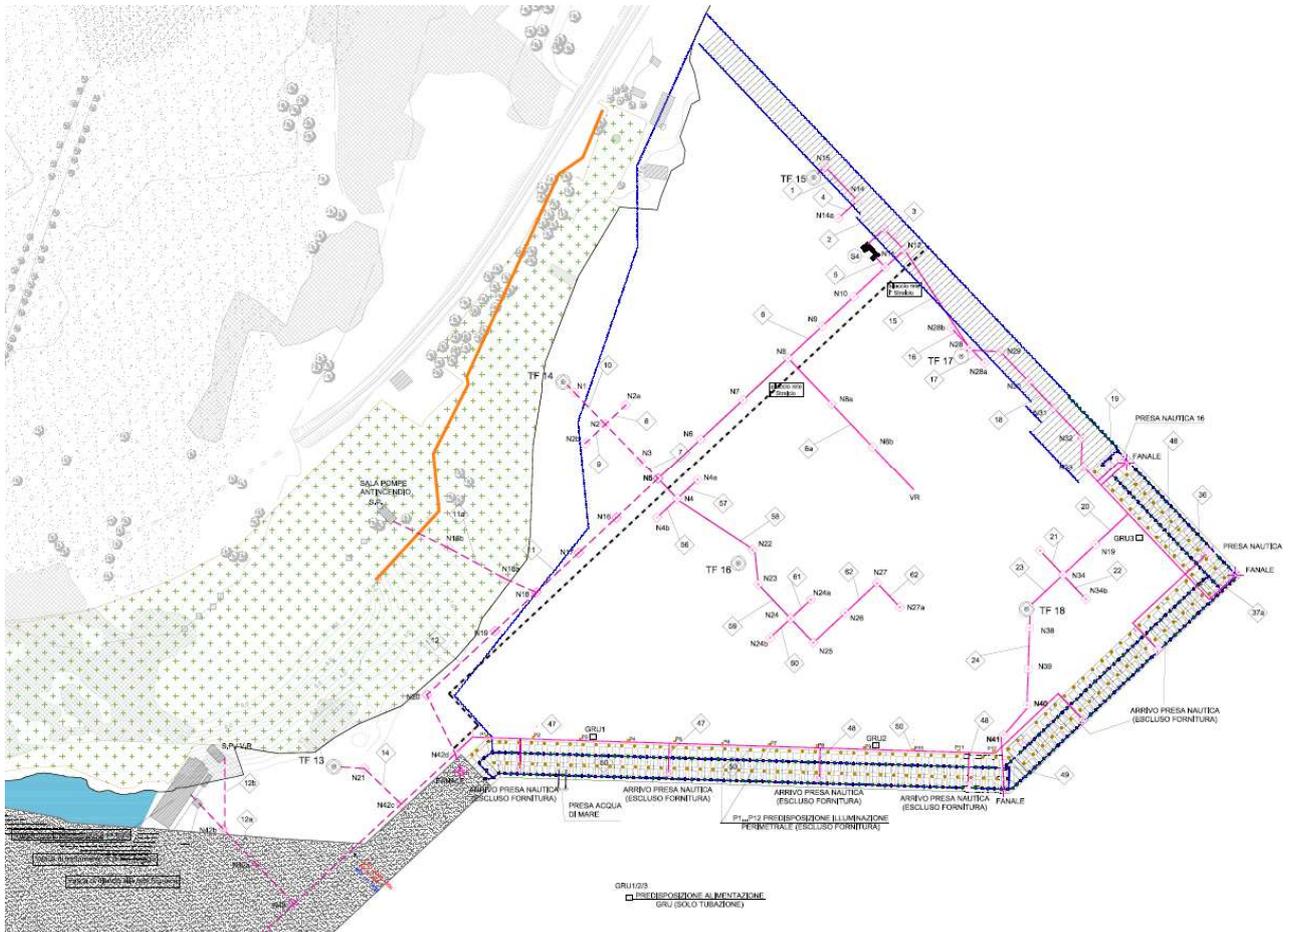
Planimetria rete elettrica esterna – Progetto Esecutivo
